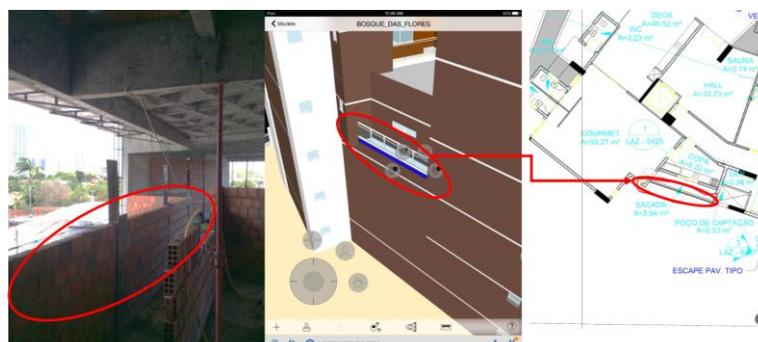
Utilização do BIM como fonte de consulta do detalhe construtivo de base para grade em fachada
